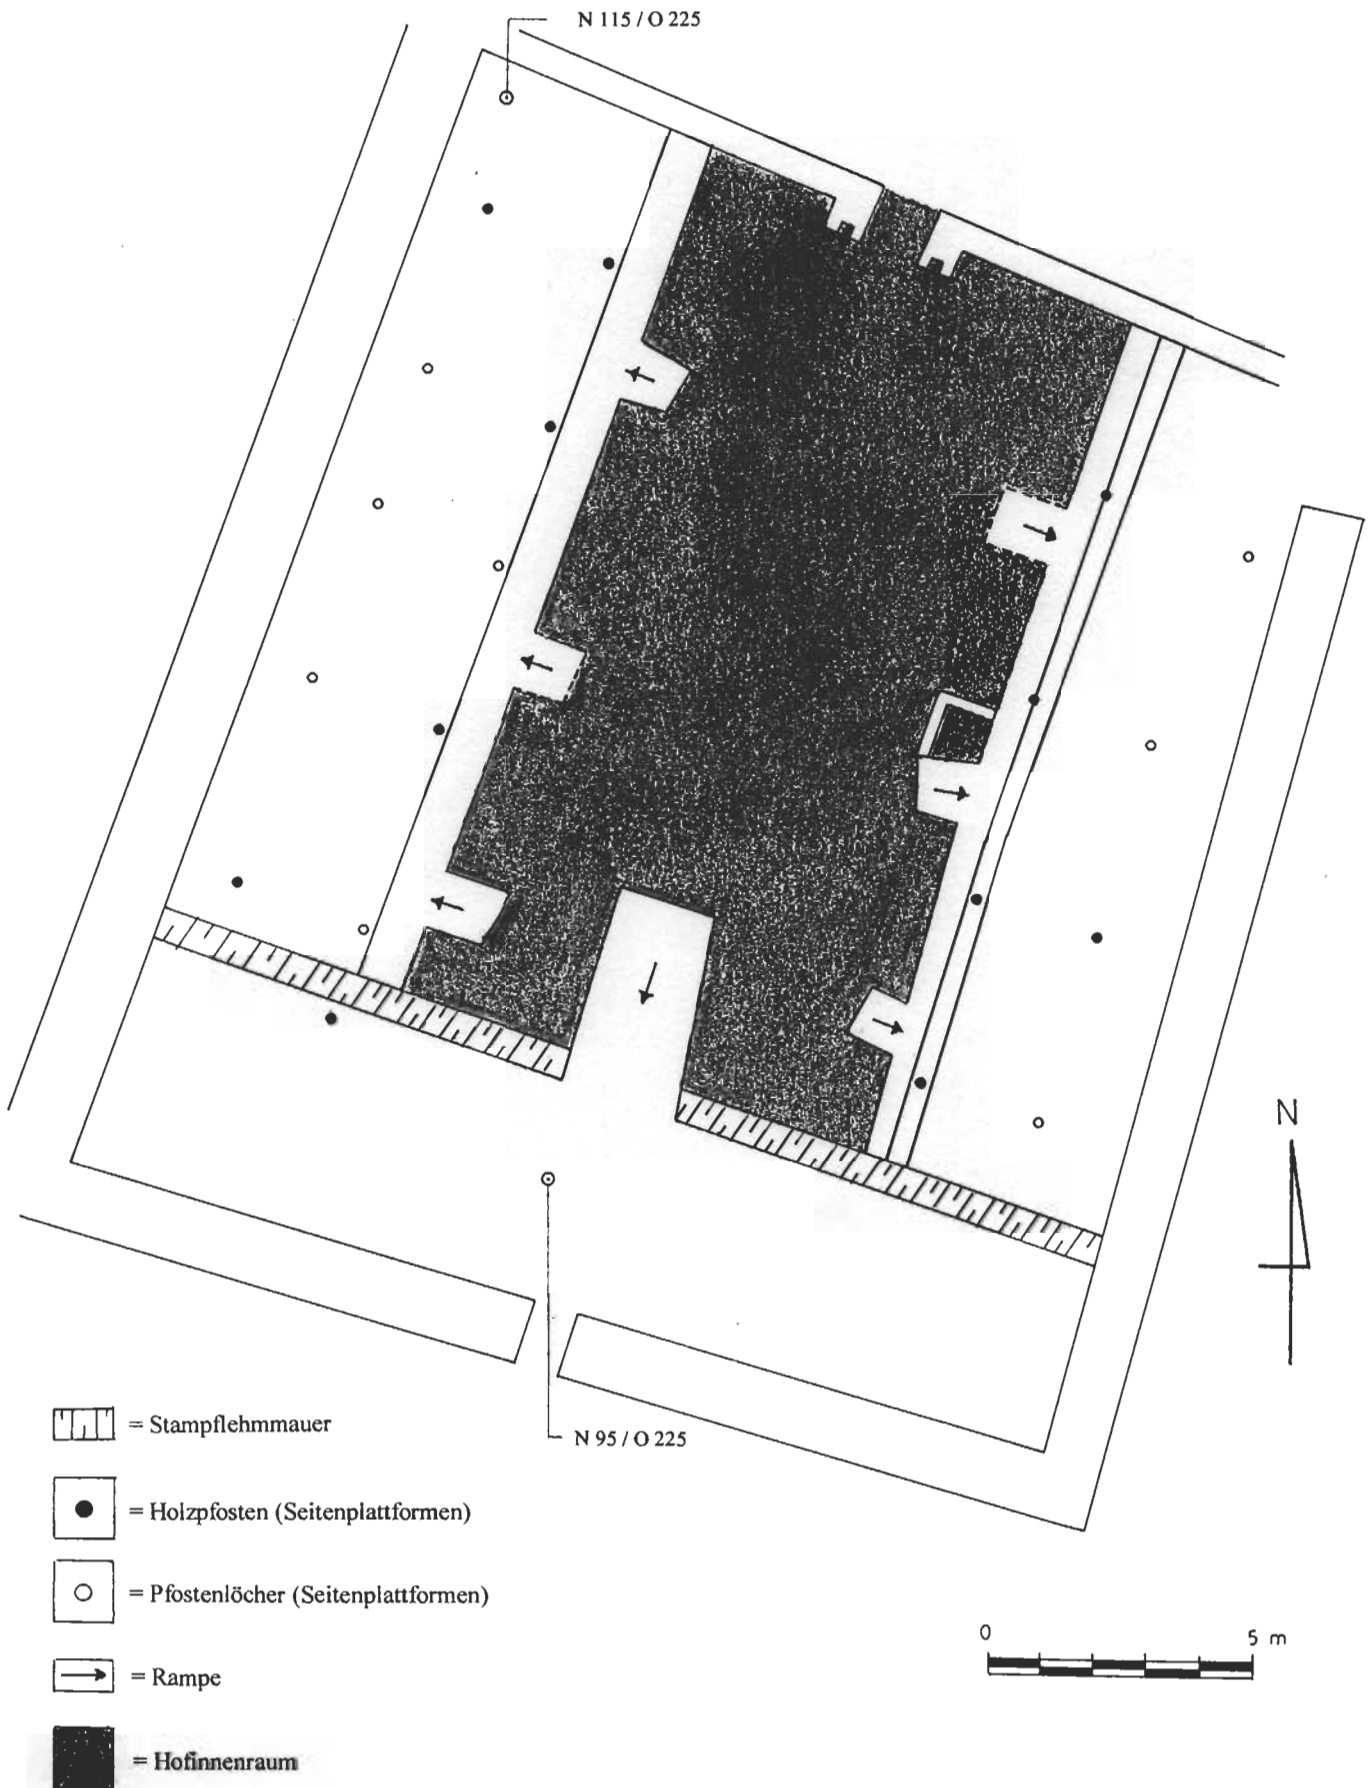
Plattformen, Rampen und Holzpfosten (S 2 – Hof 5 – letzte Konstruktionsphase)
